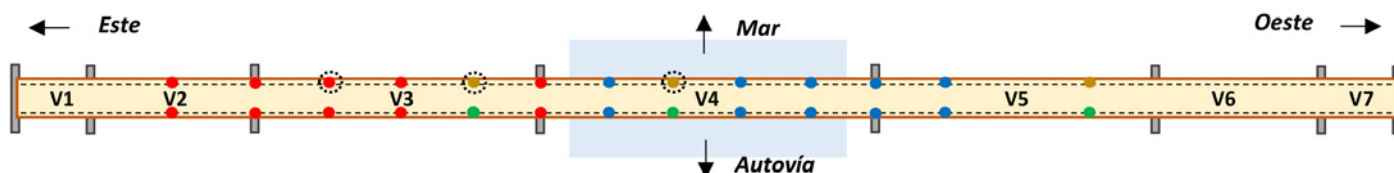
Planta conceptual, indicando la ubicación de los sensores
